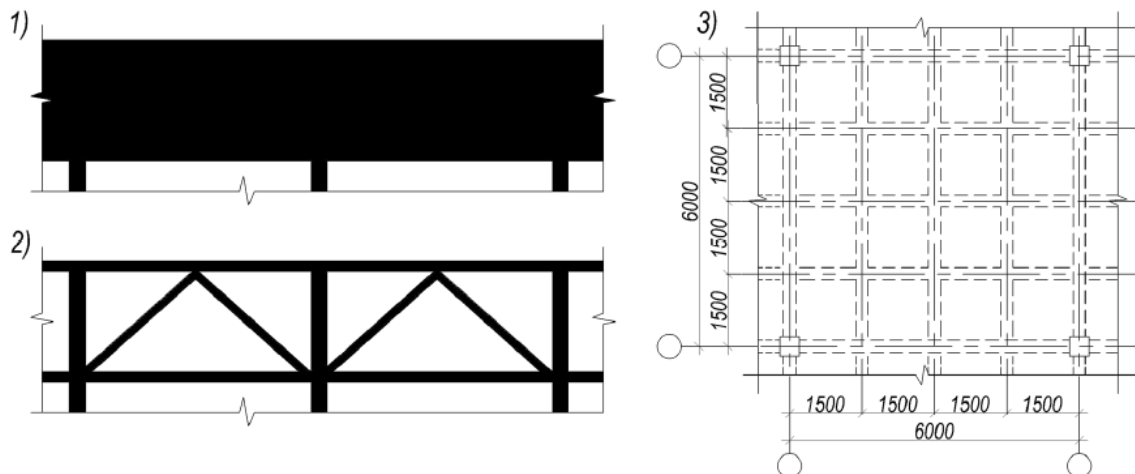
Варианты усиленных этажей: 1 – стеновая конструктивная система; 2 – стальные фермы; 3 – кессонное перекрытие
